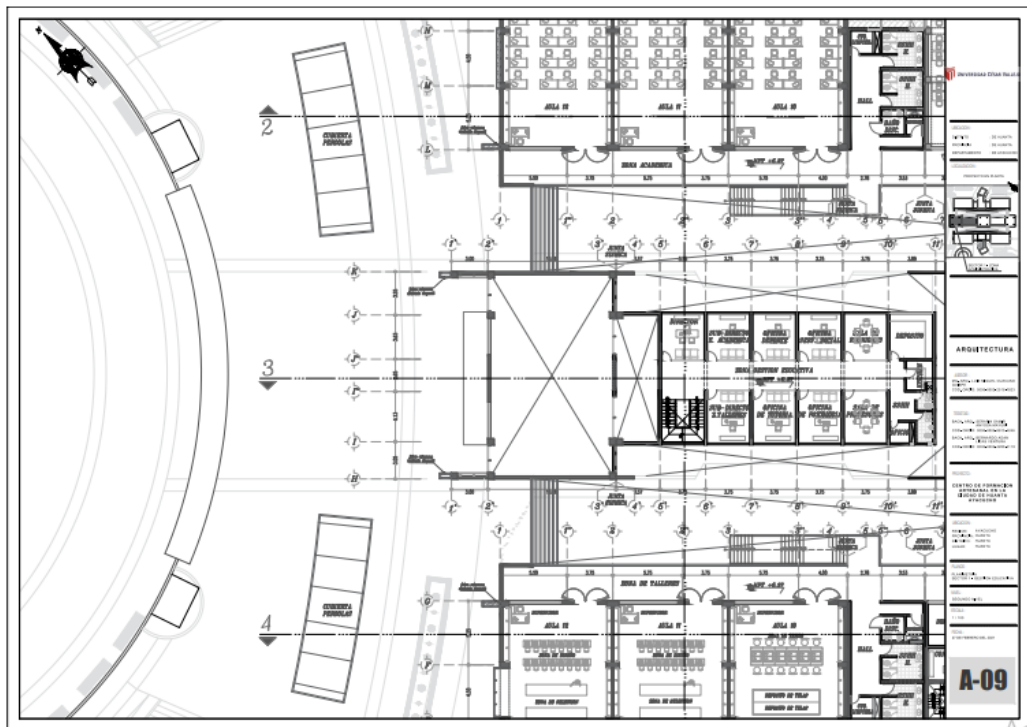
Planimetría del sector 1 ubicado en el piso 2. Escala 1/100.
